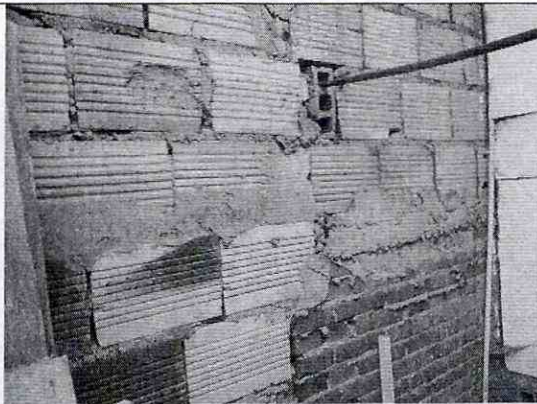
Muro de cerramiento en mampuestos de ladrillo y bloque hueco.
